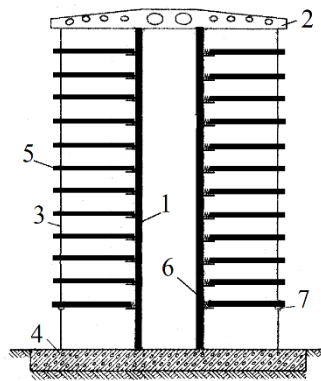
Многоэтажное сейсмостойкое здание с подвешенными этажами: 1 – ядро жёсткости; 2 – пространственная консольная ферма; 3 – подвески; 4 – фундамент; 5 – перекрытия; 6 – шарниры; 7 – выключающиеся связи
